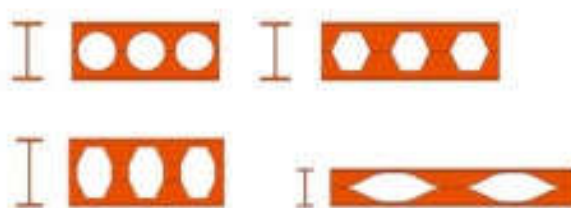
Exemples de poutres ajourées ou alvéolaires.
